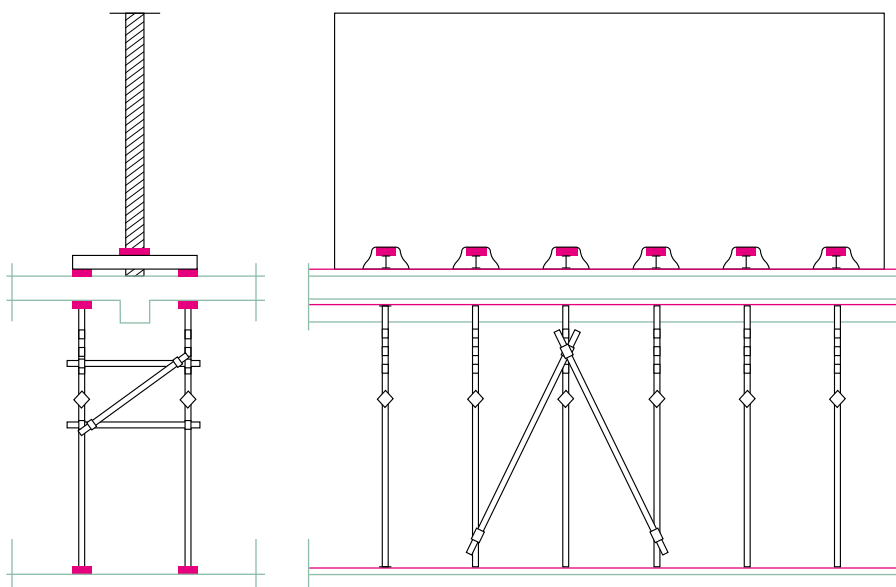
Apeo de una viga con descarga de muro. Perfil y alzado.
